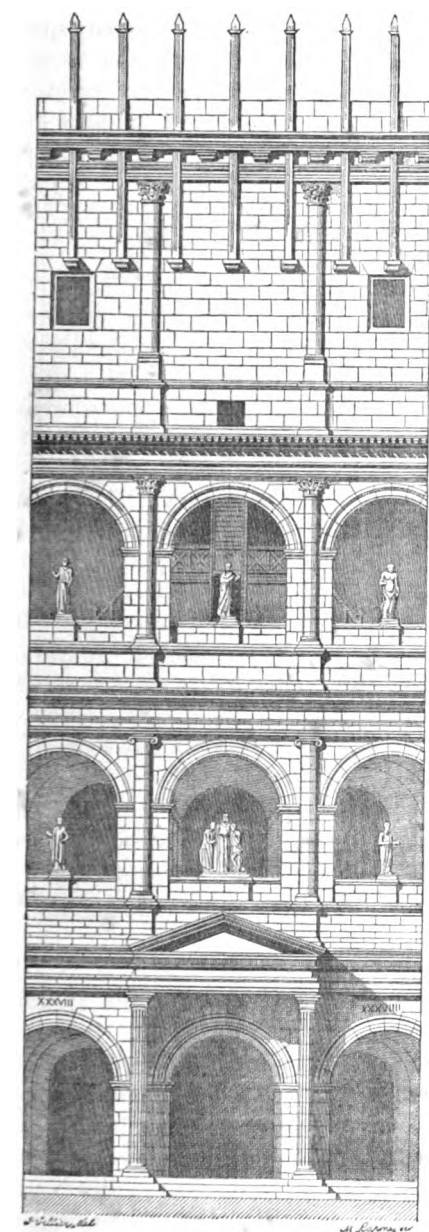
Amphithéâtre Flavien. Section de la façade restaurée.
